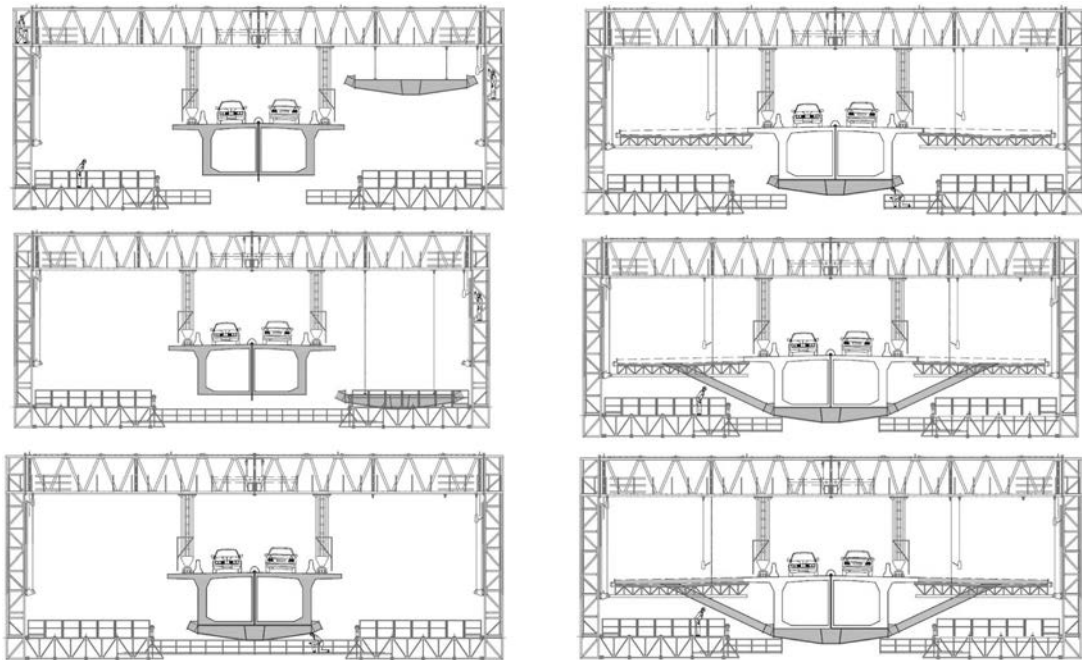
Cimbra móvil para la instalación de jabalcones y hormigonado de la losa ampliada.
